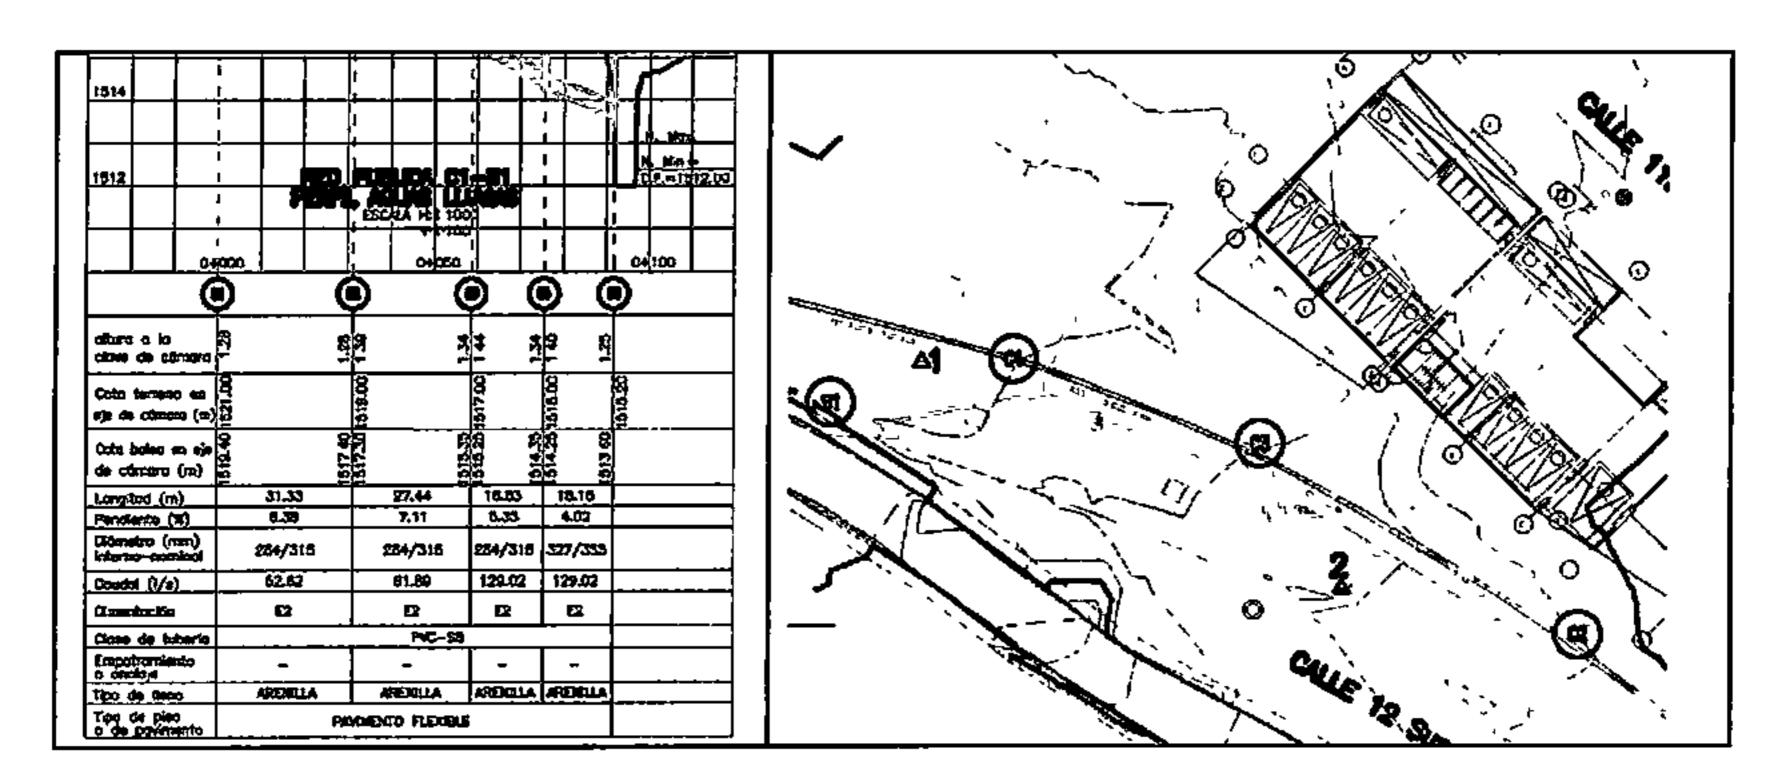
Perfil Transversal de la descarga proyectada y Vista en Planta.
